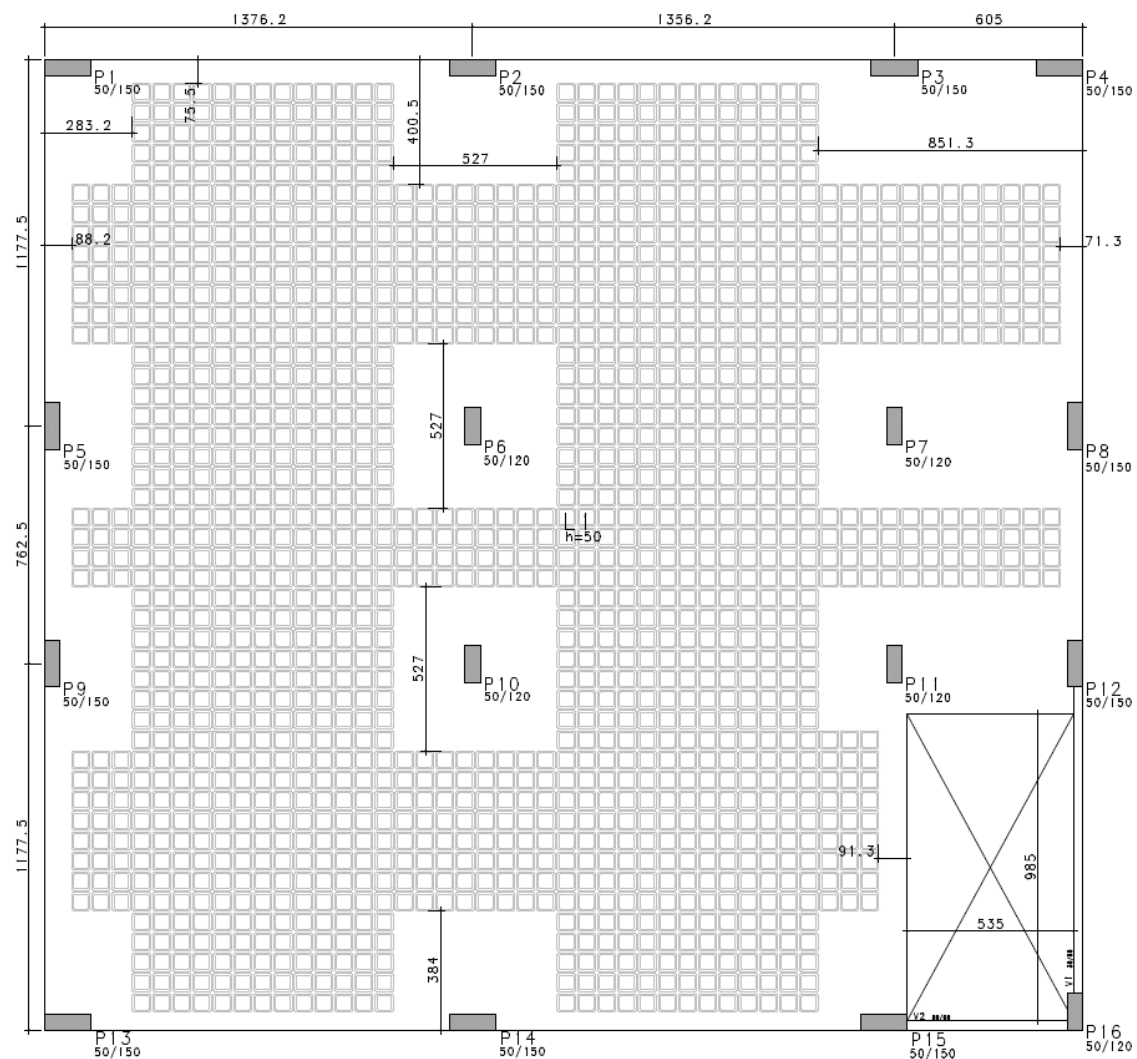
Projeto C1 - Planta de forma (dimensões em cm).
